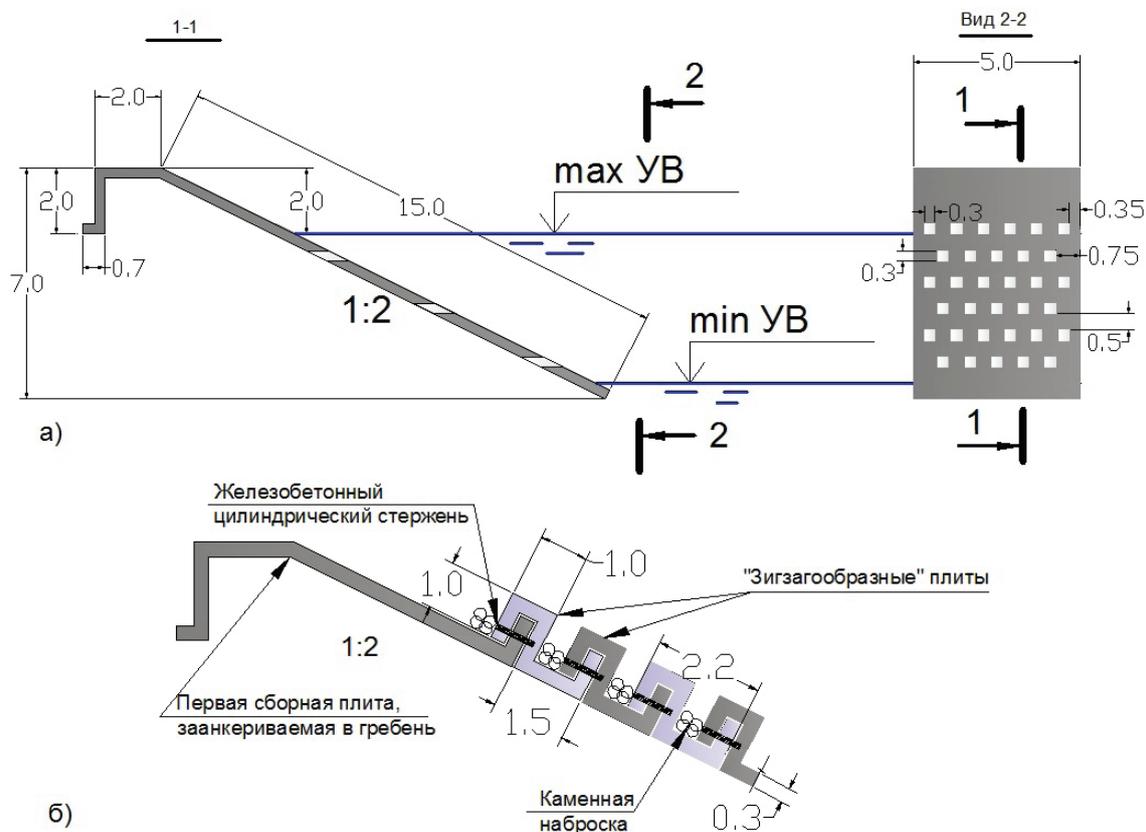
Конструкция сборной железобетонной плиты для защиты откосов грунтовых и каменно-набросных сооружений от волновых и ледовых воздействий (размеры в метрах):
